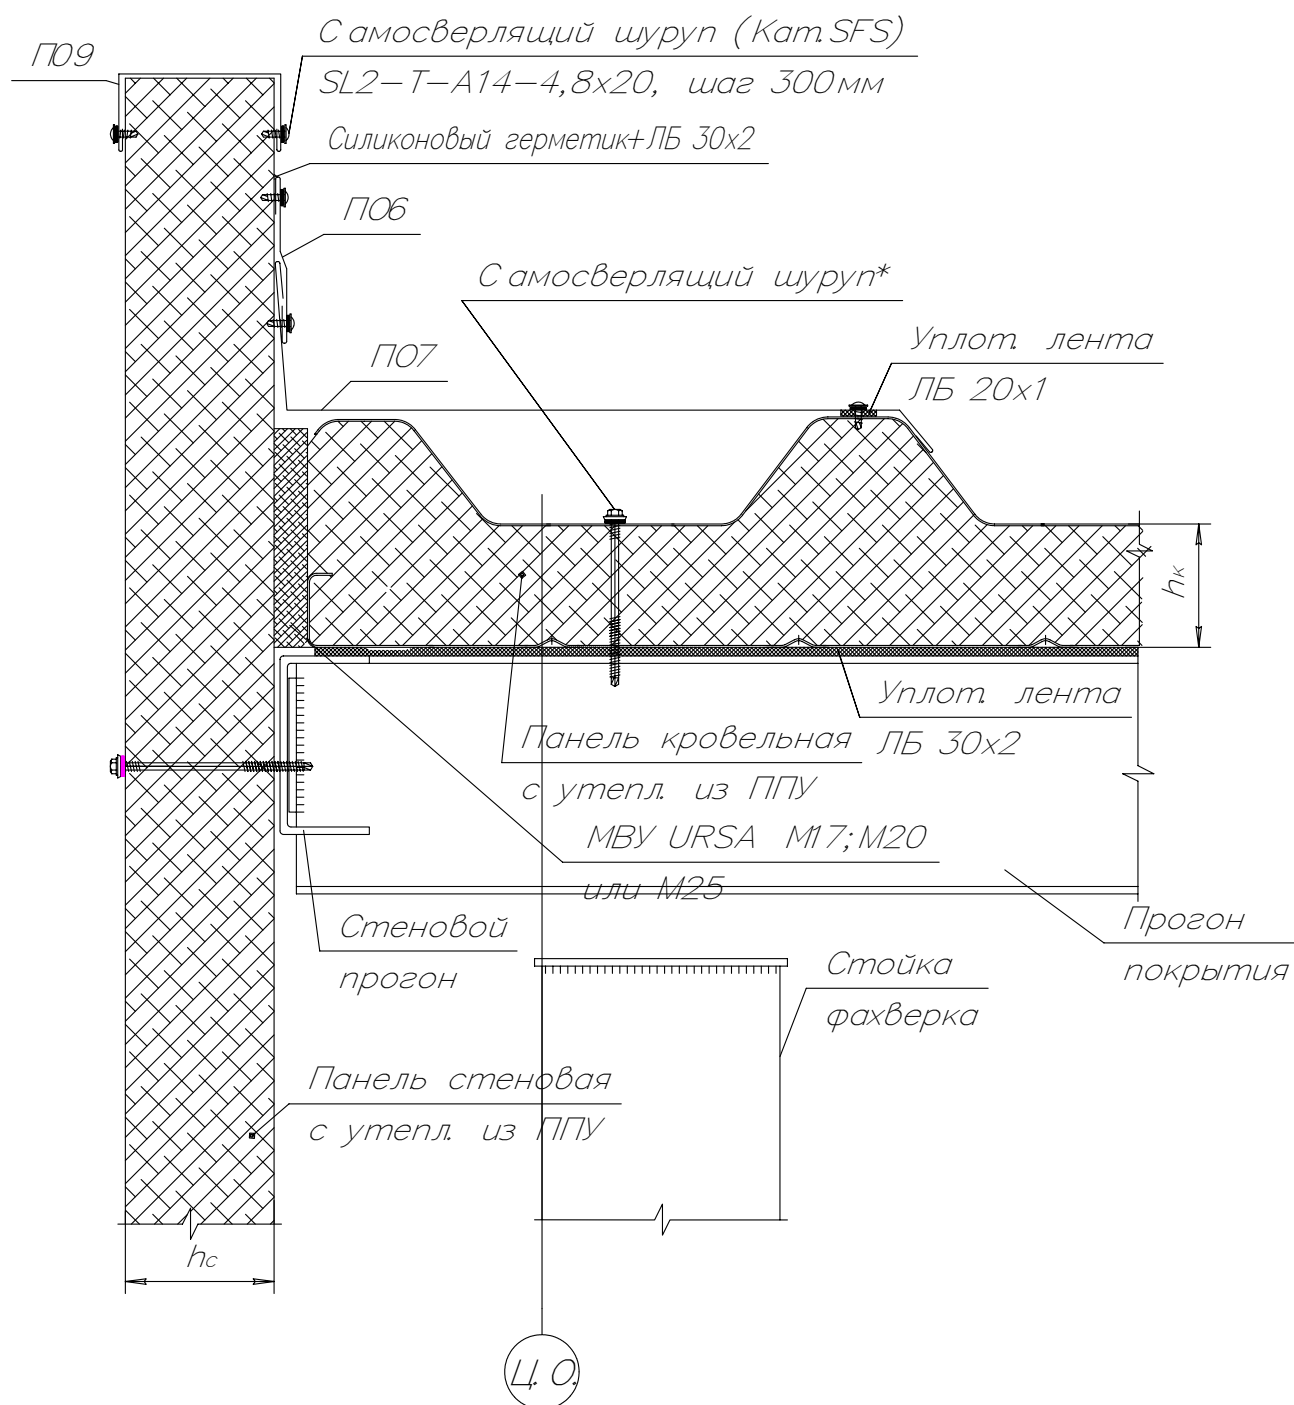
Сопряжение кровельных панелей со стеной (продольное)
